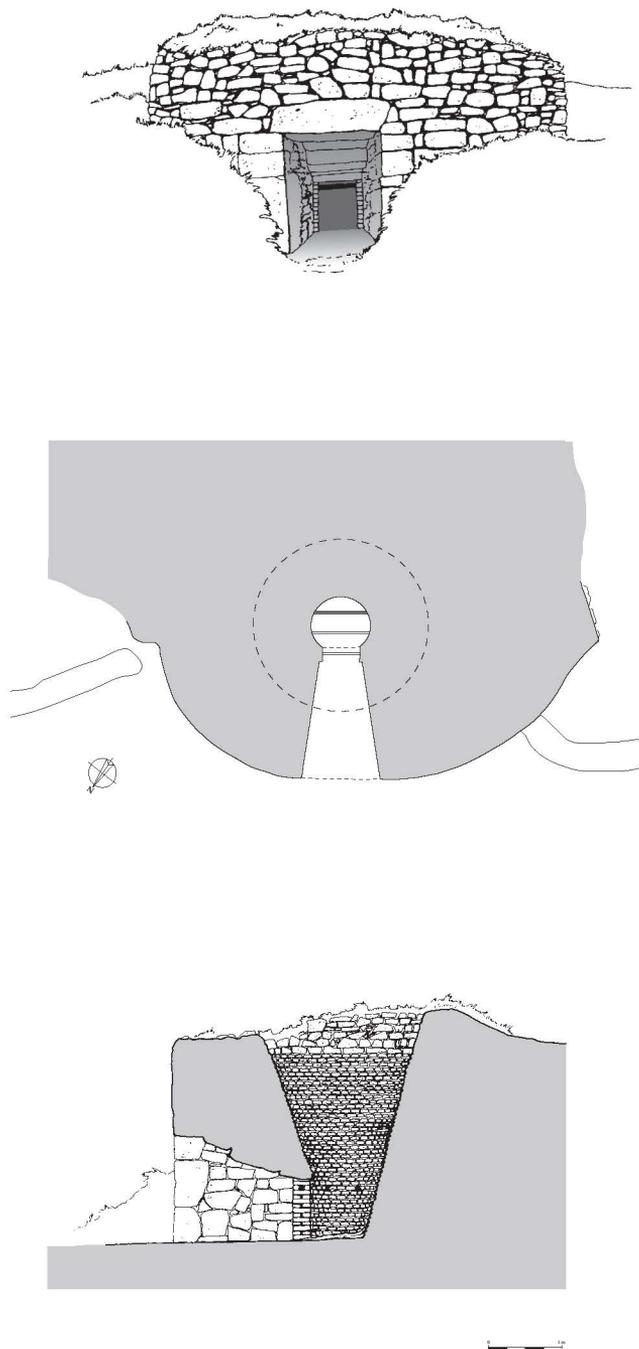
Alzado, planta y sección del calero del Lugarín (Villaperi, Oviedo).
